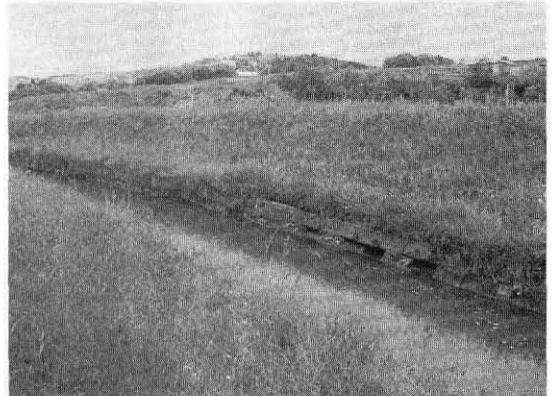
菅生排水路・空積コンクリートブロックの局部的損傷状況
